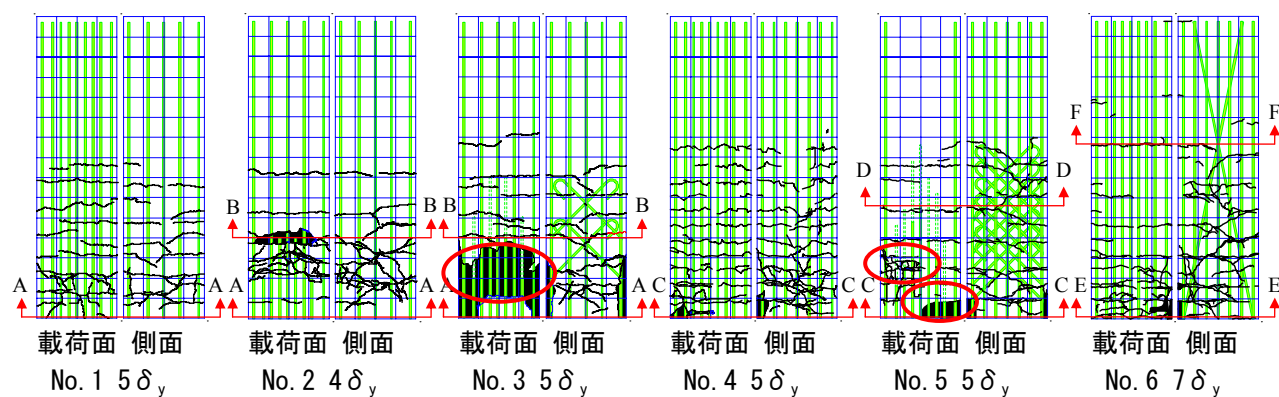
各試験体のかぶり剥落直後のひび割れ状況
